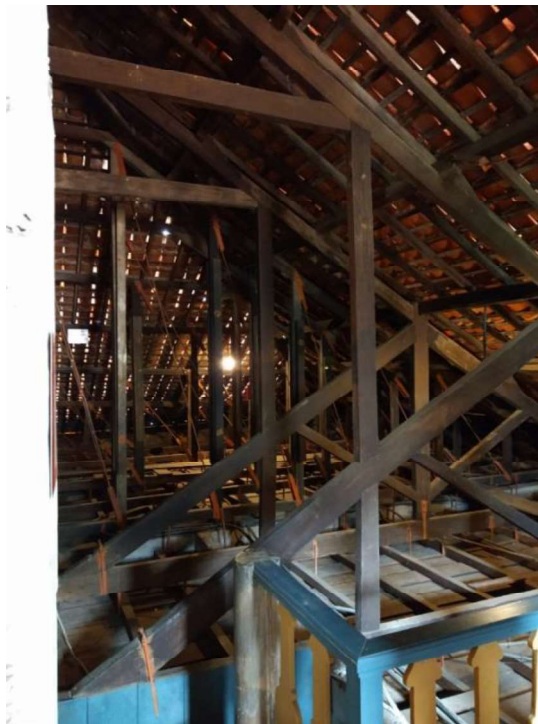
Tesouras do telhado sobre o segundo pavimento.
